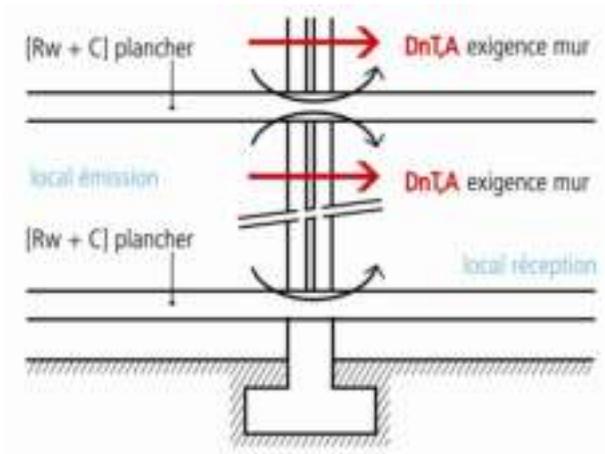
Plancher continu plein ou plancher corps creux sur vide sanitaire et double mur lourd.
